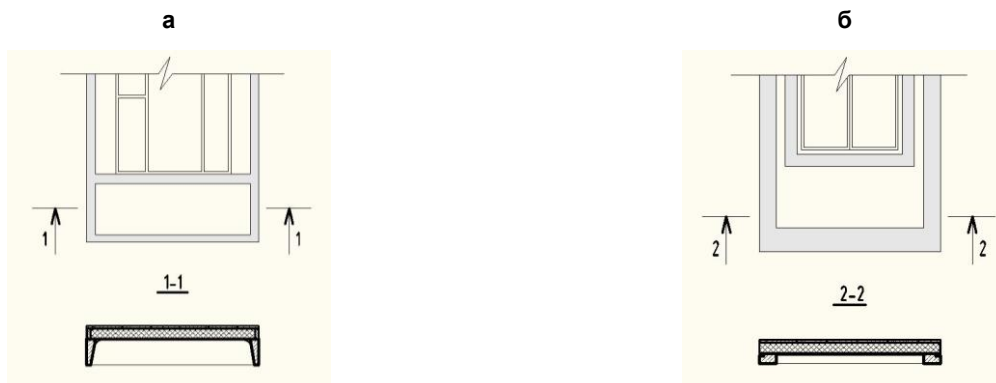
а) элемент фасадной плиты серии 7018 БМЗ с сечением 1-1; б) элемент вновь запроектированной фасадной плиты БМЗ с сечением 2-2
